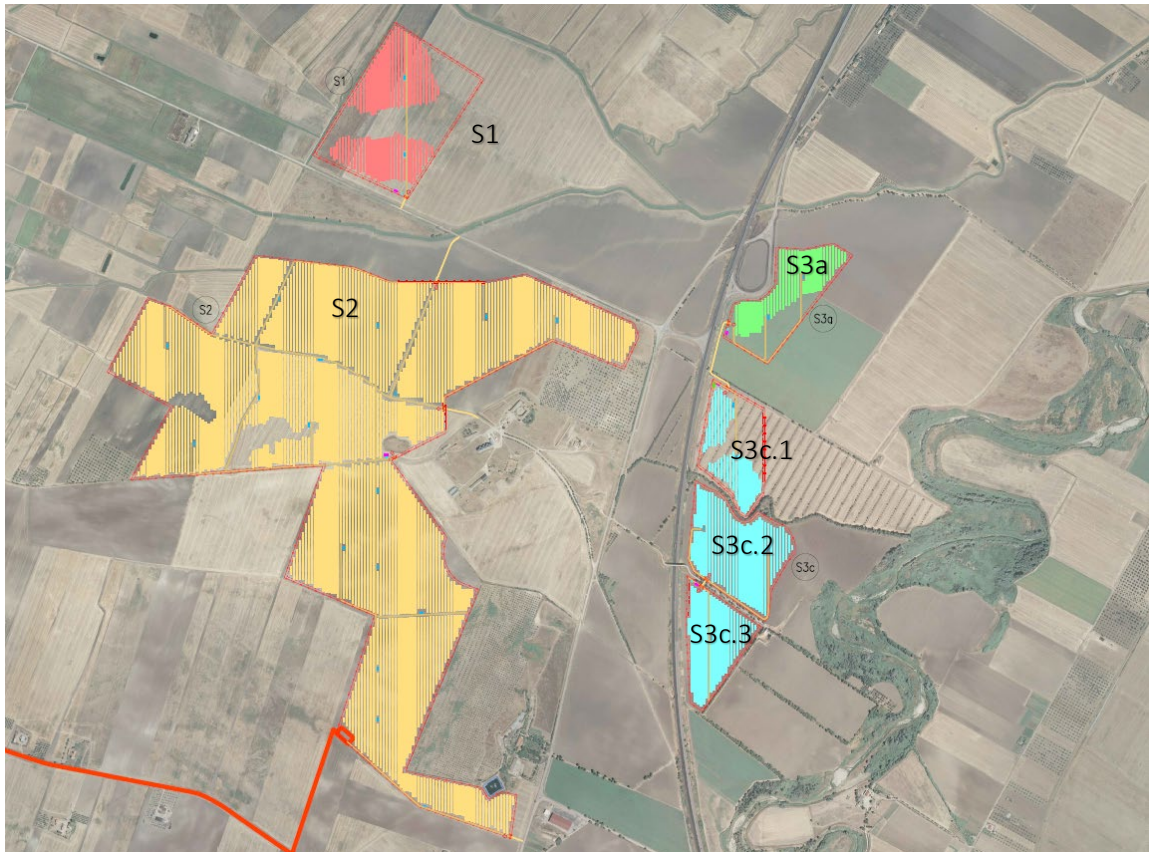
Layout di progetto dell'impianto fotovoltaico.
